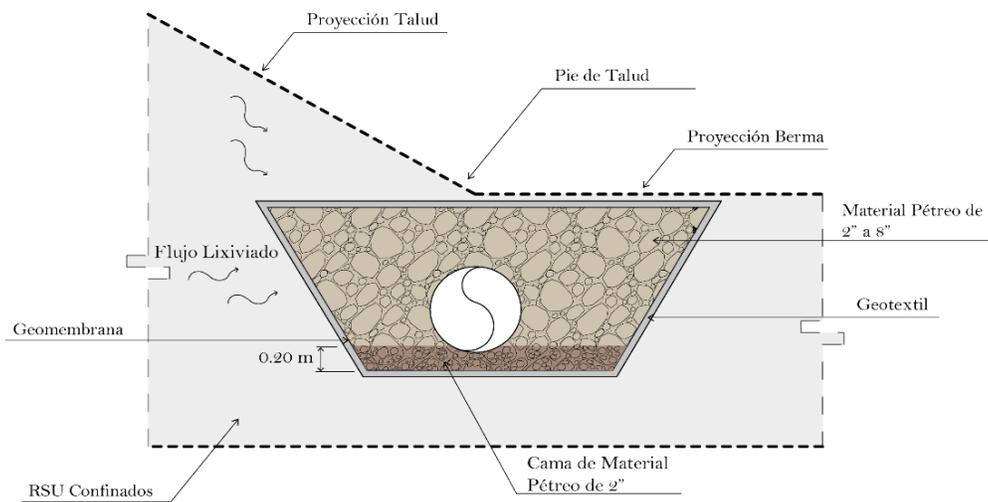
Diagrama de alternativa de dren perimetral en talud intermedio con tubo central y cubierta de geomembrana para la captación de lixiviado a pie de talud
